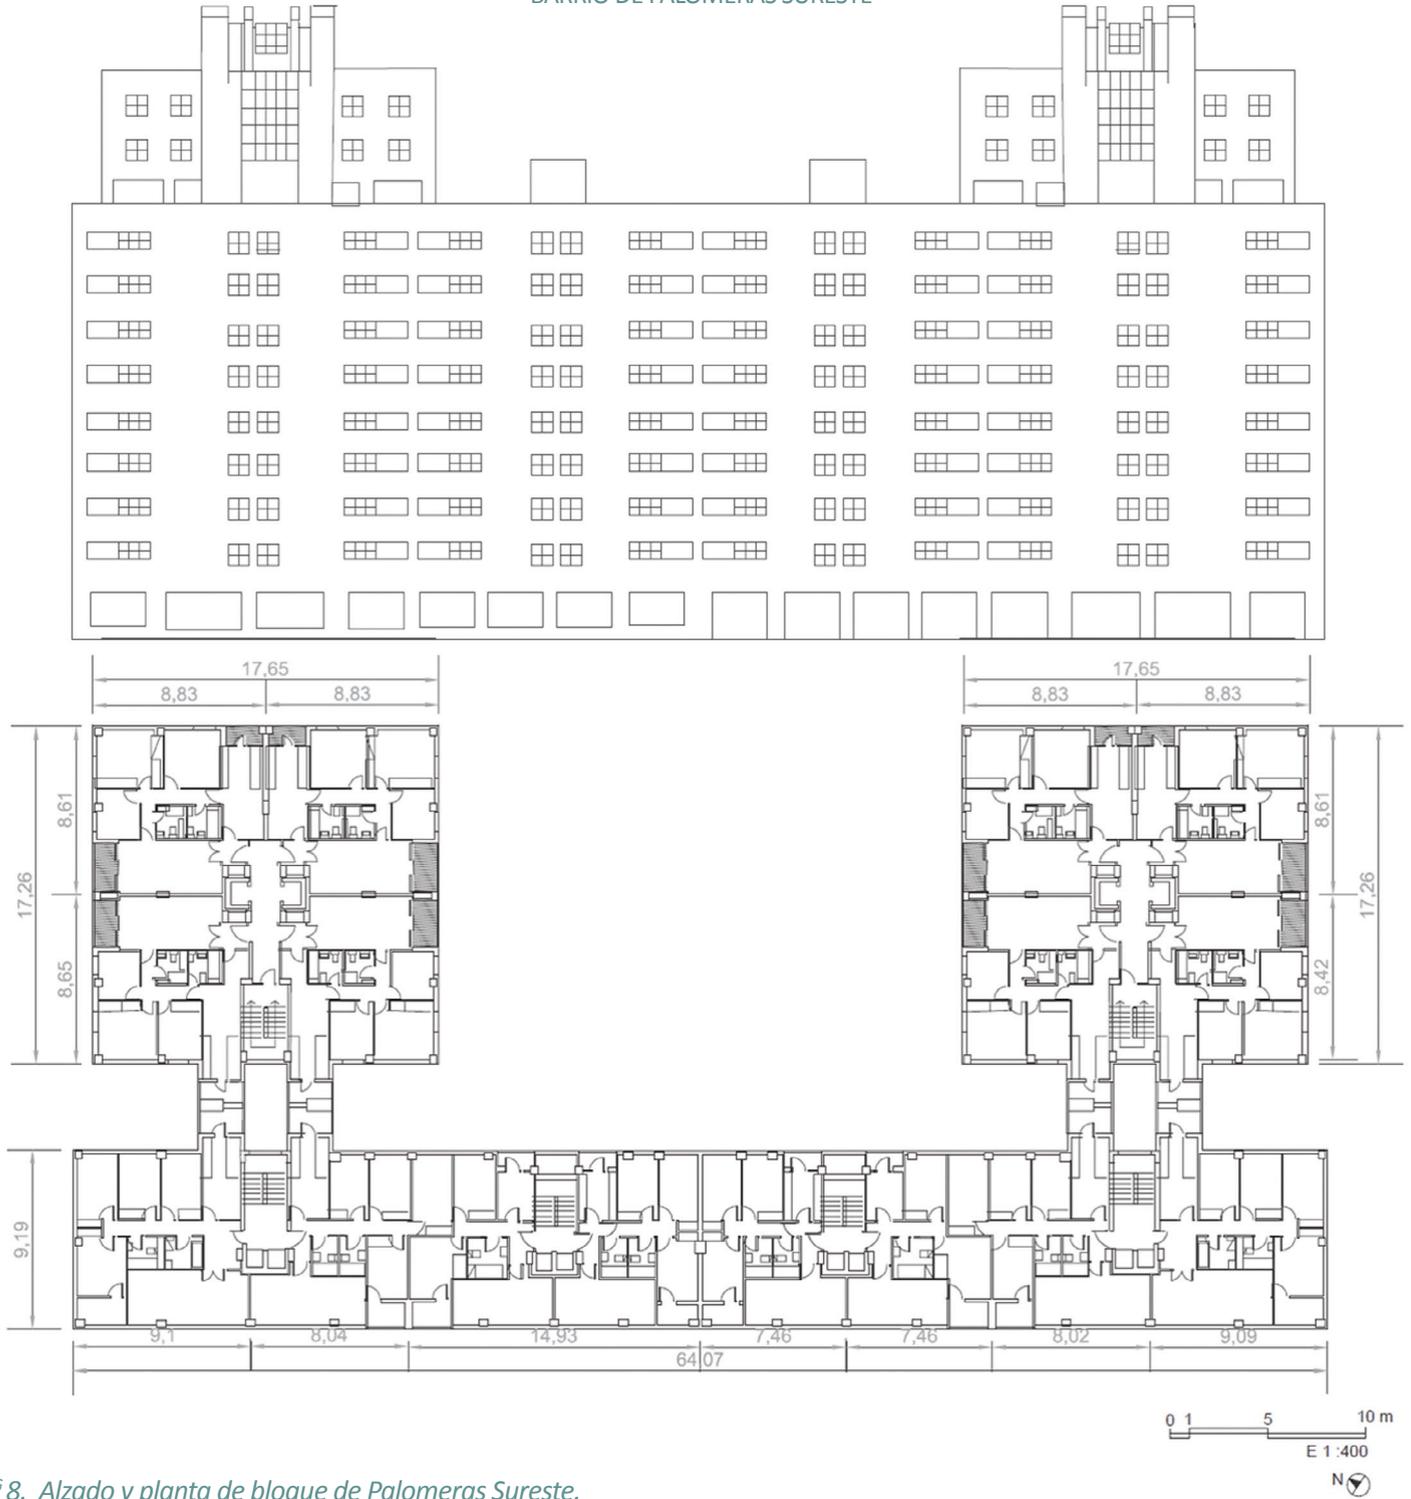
Alzado y planta de bloque de Palomas Sureste.
